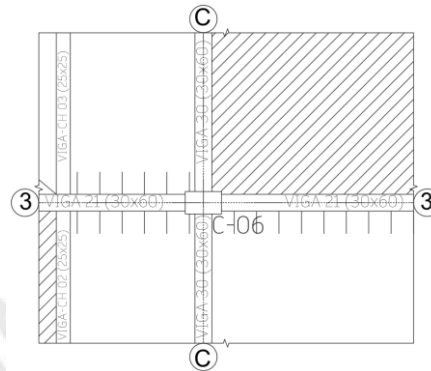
Cimentación aislada, perteneciente a la columna C-06 entre los ejes 3 y C
